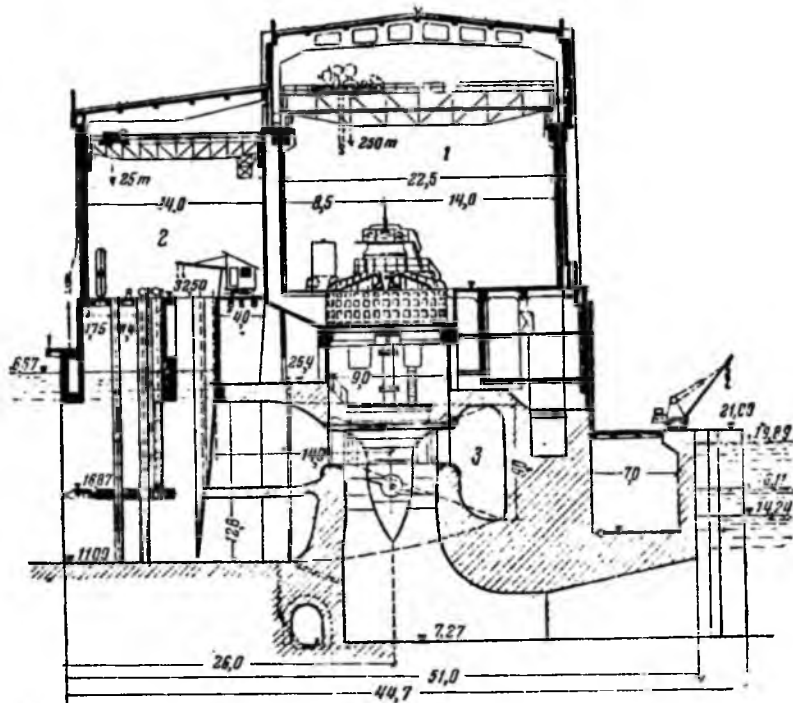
Поперечный разрез главного здания ГЭС (размеры в метрах)
